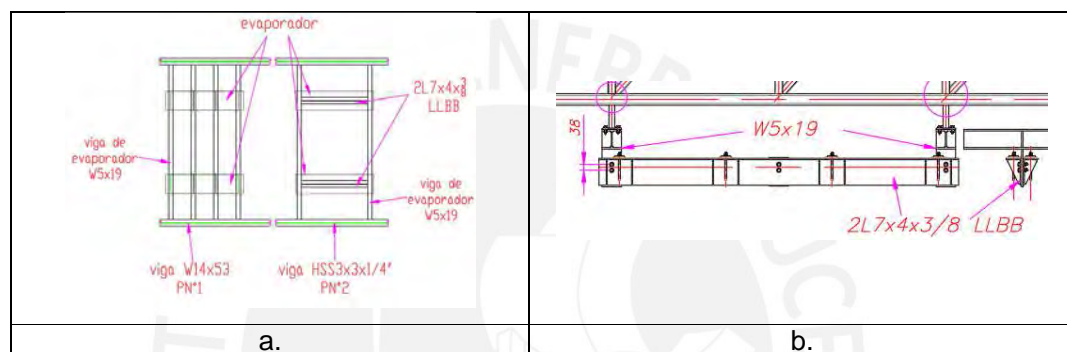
a. Distribución de vigas de evaporador PN°1 y PN°2, b. Ángulo 2L 7x4x3/8"
